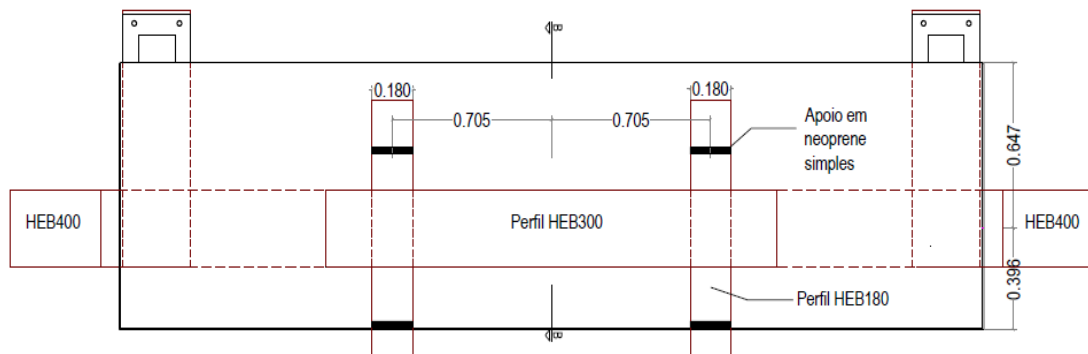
Corte A-A da Figura 5.1. Vista superior do esquema de ensaio (dimensões em m)
